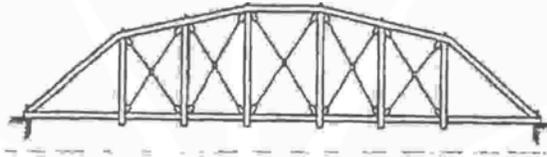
Jembatan Rangka Baja Tipe *King-Post
